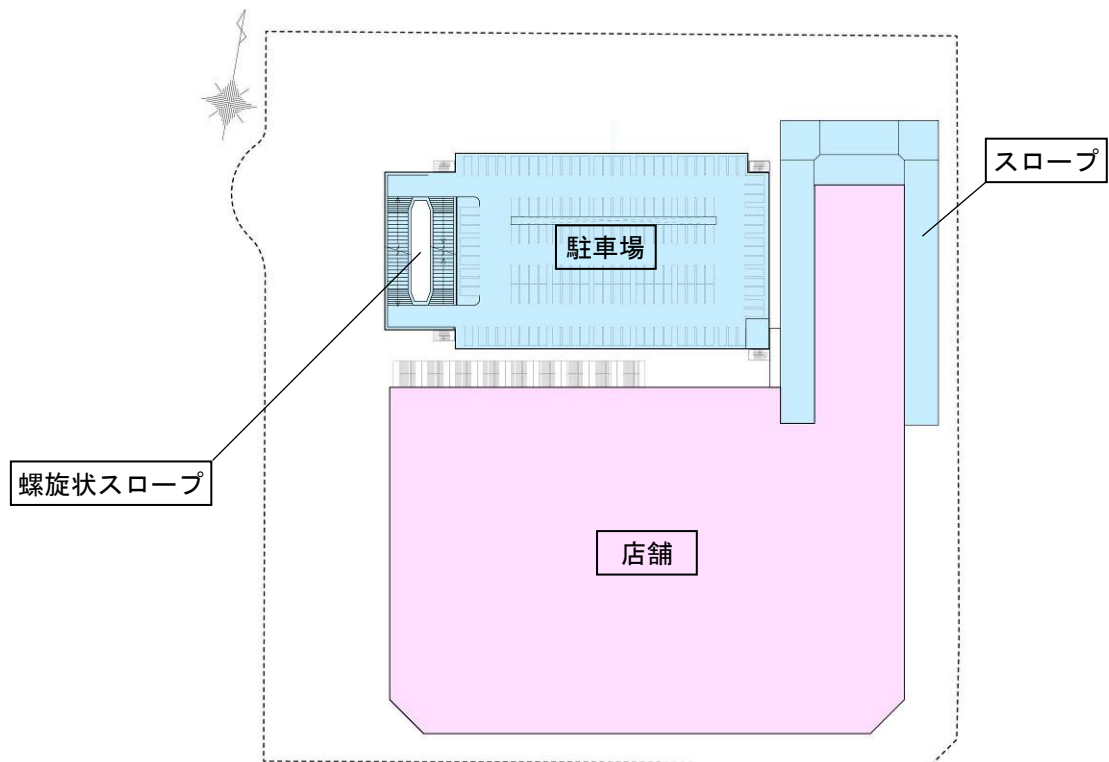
(4) 各階平面図(商業棟 4 階, 駐車場棟 5~6 階) 【評価書時】
